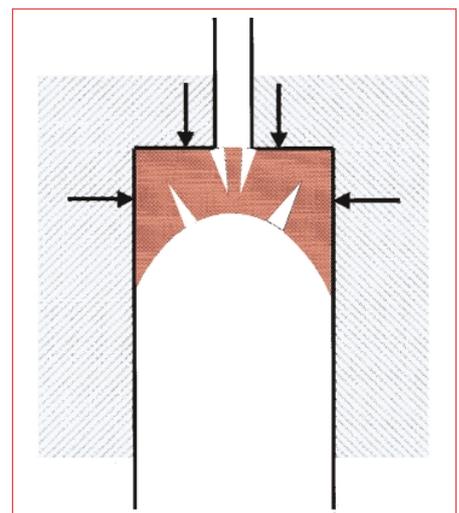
Bewegungsfuge (fehlerhafte Ausführung): Haftung an drei Flanken
